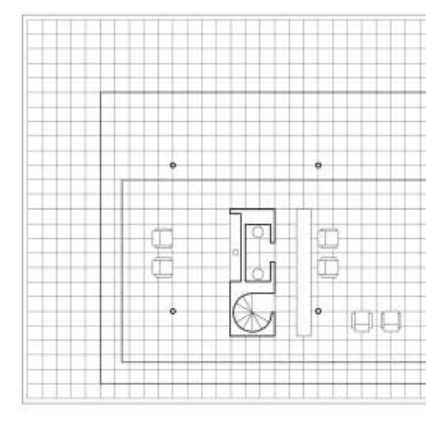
Detalle de la planta de la casa Olnick Spanu, New York, (2008). Autor: A. Campo Baeza
